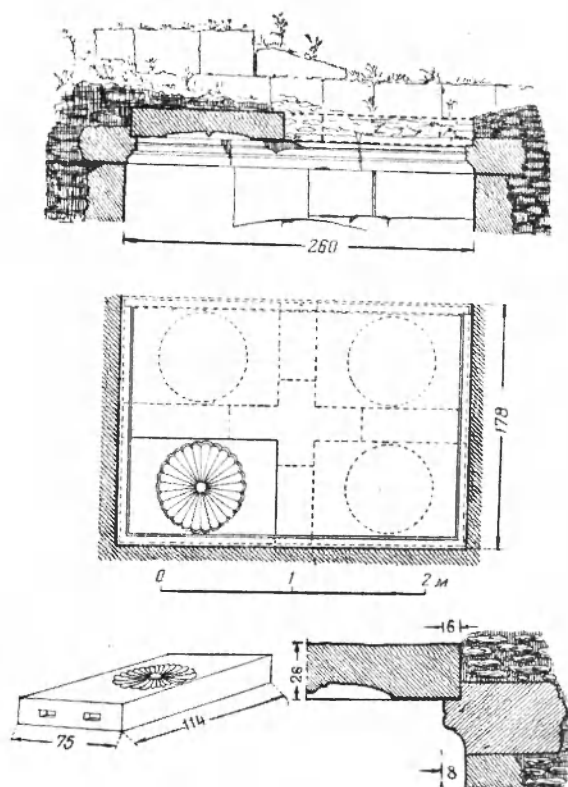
Тегеняц. Конструкция плоского каменного перекрытия северо-восточной угловой части жаматуна
